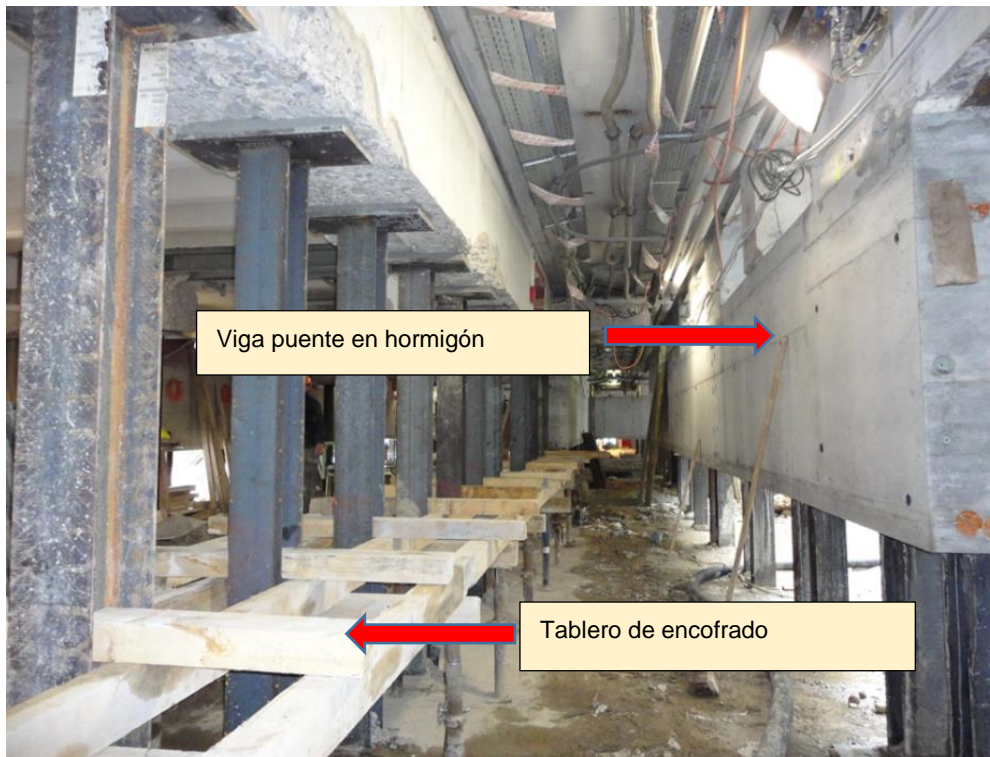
,. Fase con pilares empotrados en viga y base encofrado de viga puente
